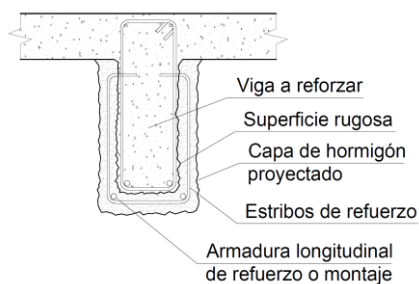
Refuerzo de viga mediante hormigón proyectado
